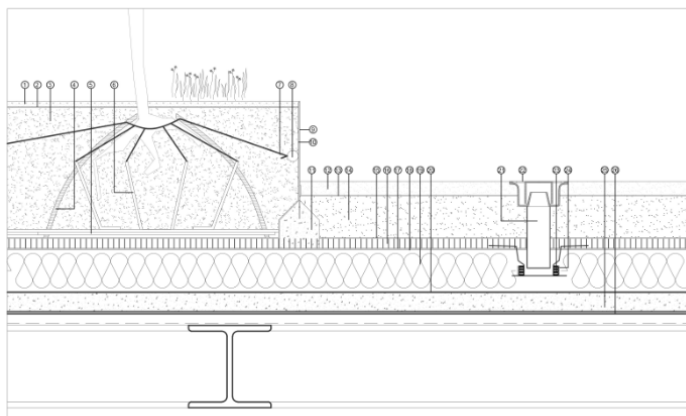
Detalle de encuentro del envoltorio con estructura principal. Fuente: Propia.
